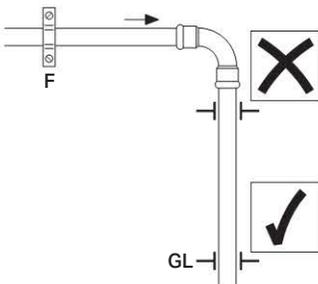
Placement des points coulissants: la conduite horizontale doit pouvoir se dilater librement
